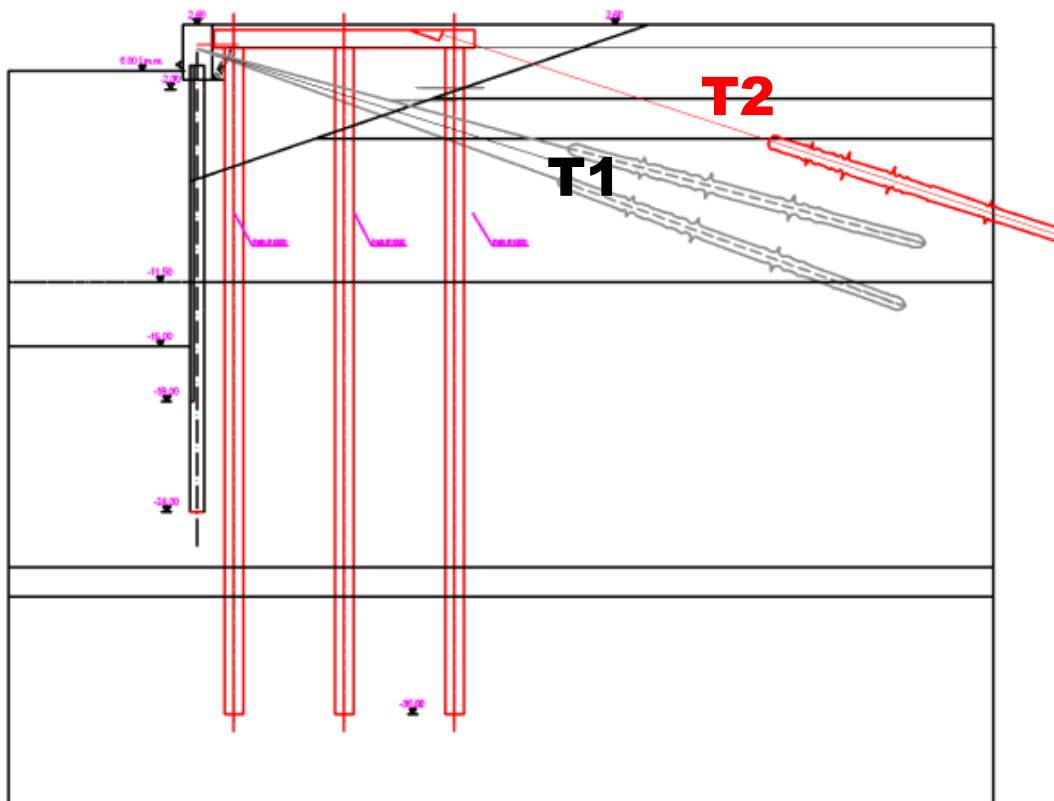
Sezione tipo intervento di adeguamento con indicazione dei tiranti di ancoraggio
